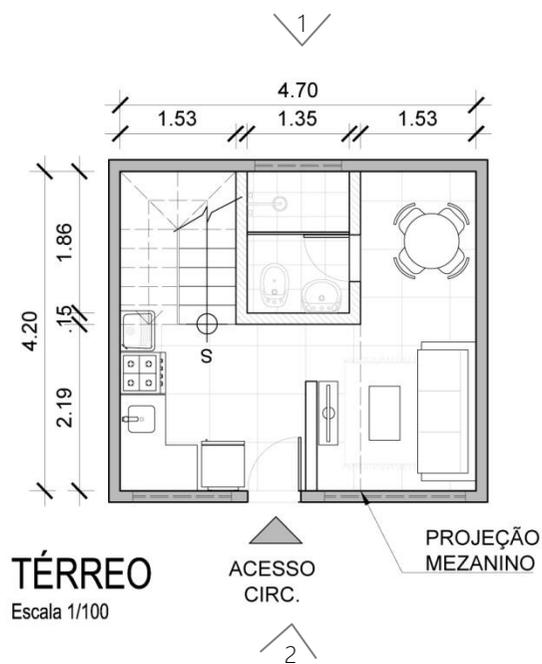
Situação em planta apartamento 1 quarto duplex. Fonte: Elaborado pela autora.
